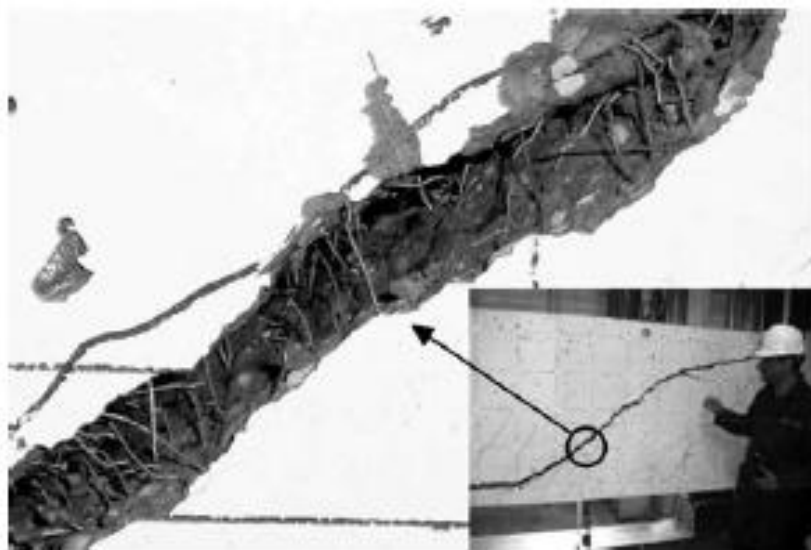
Fissura após ruptura em viga parede. (SHOAIB *et al.*, 2014)
